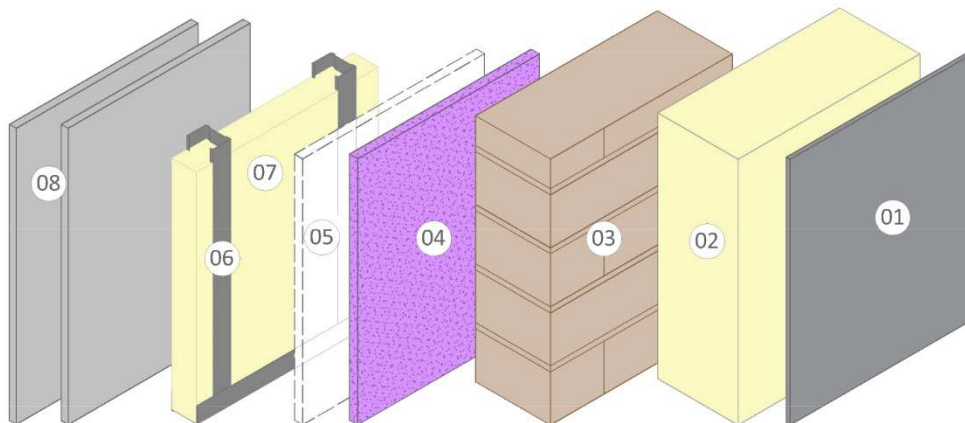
Sección vertical de un ejemplo de uso de Placo® Hermetic en fachada ventilada.
